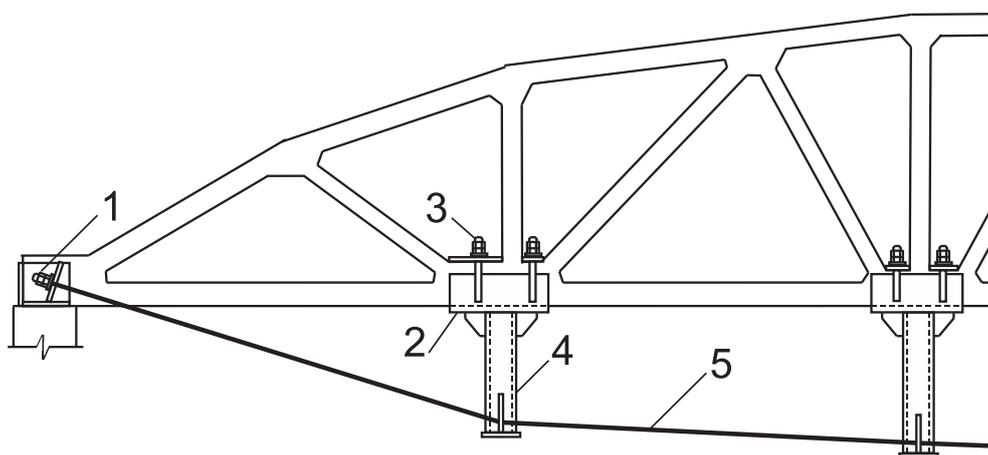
Схема усиления железобетонных ферм путем изменения конструктивной схемы с обустройством шпренгеля из стальных тяжей: 1 – упор для натяжения; 2 – швеллер; 3 – шпильки с пластинами в узле; 4 – трубчатый стояк с проушинами; 5 – тяж из круглой стали
